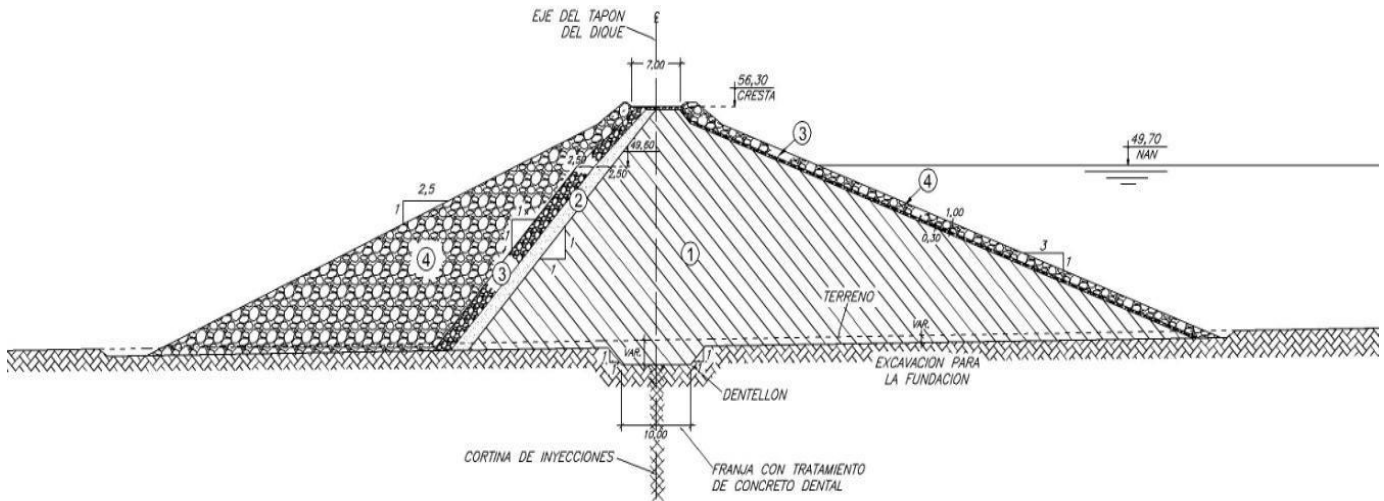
Sección Transversal del Tapón de Cierre de la Brecha
